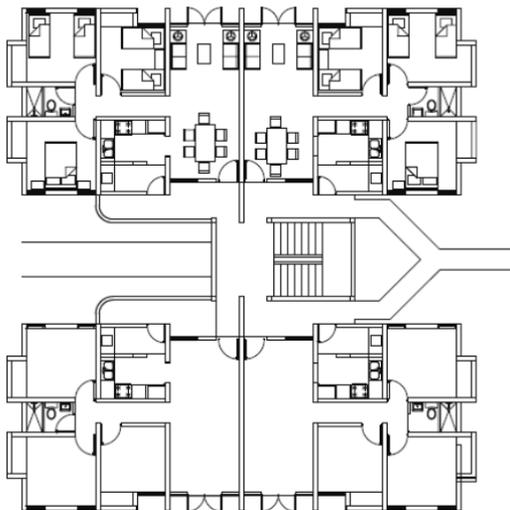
Plano de un edificio con planta H, tipología utilizada en los sectores de Hainamosa e Invivienda. Habitualmente construidos con cuatro niveles.
